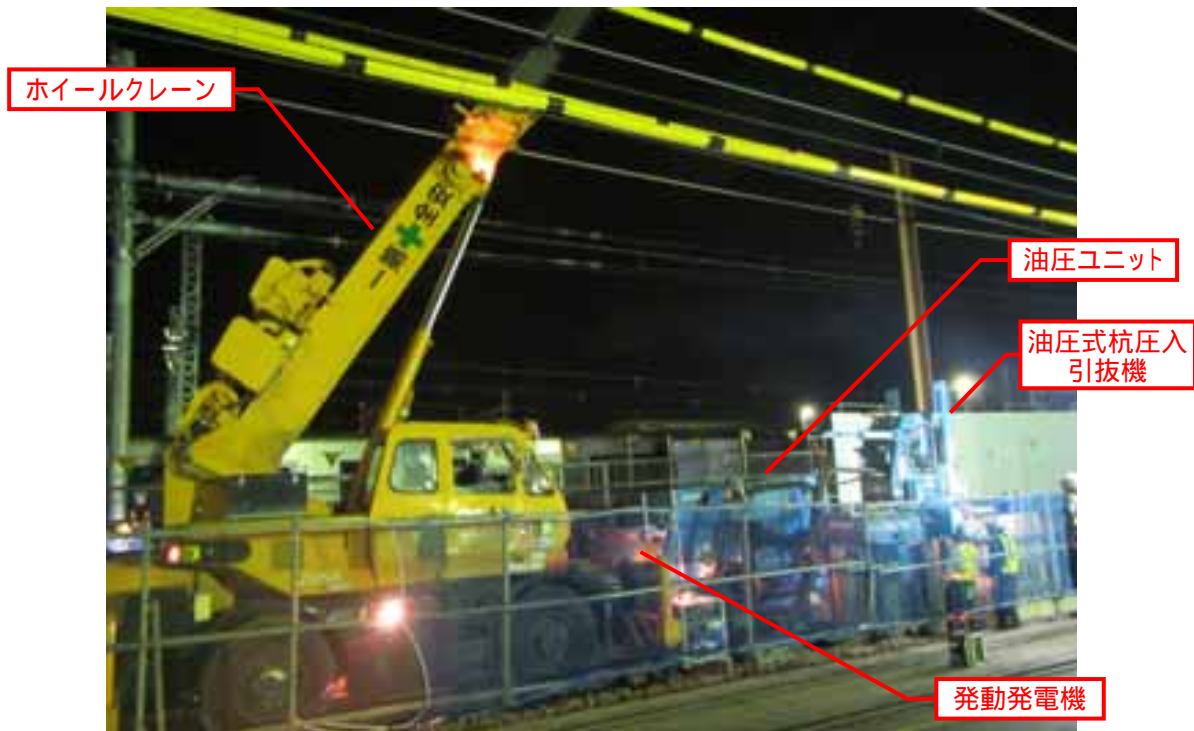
東 No.2 (躯体工) の施工状況 (平成 29 年 4 月 26 日)
